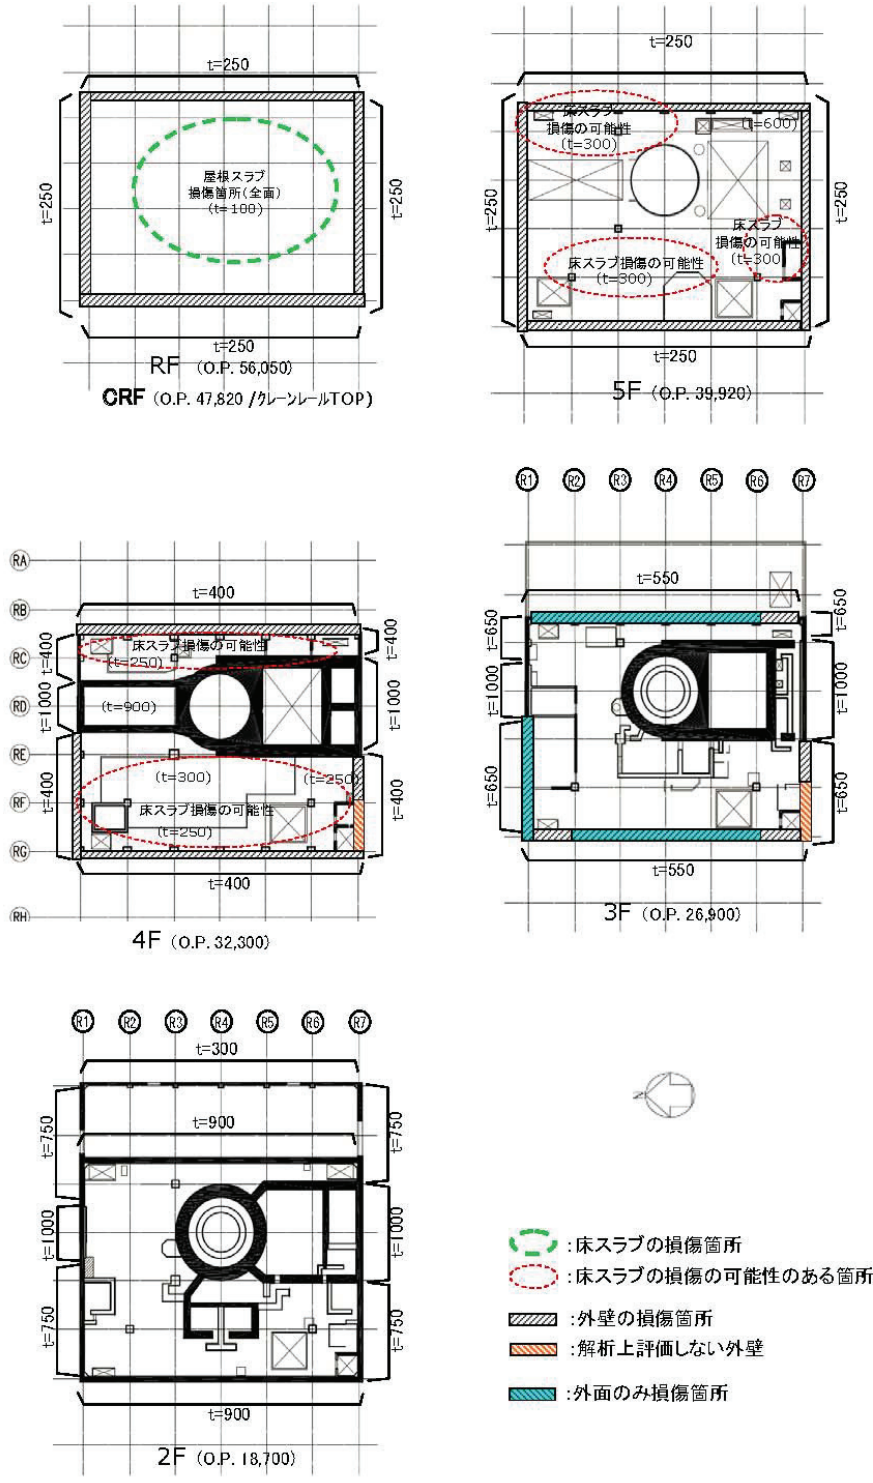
4号機原子炉建屋の損傷状況(平面図)
